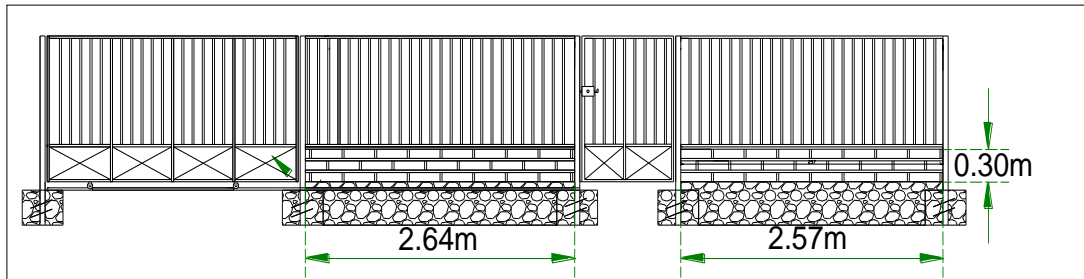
Detalle Base de Ladrillo 30x8x24 cm. Fuente: Propia
